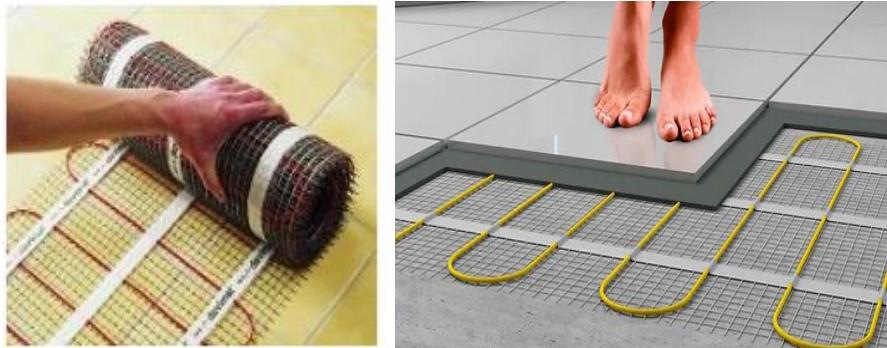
Нагрівальні кабелі у конструкції перекриття («тепла підлога»)
